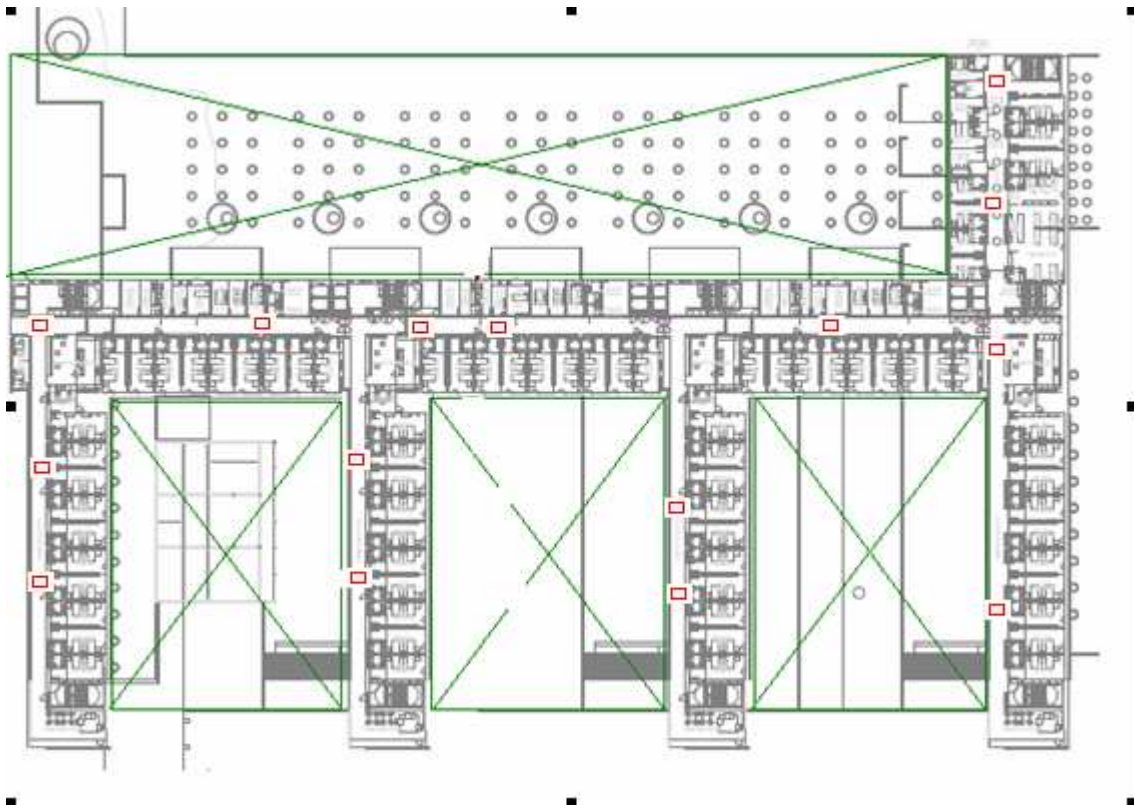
Plànol Planta 1 (P1) amb punts d'accés
